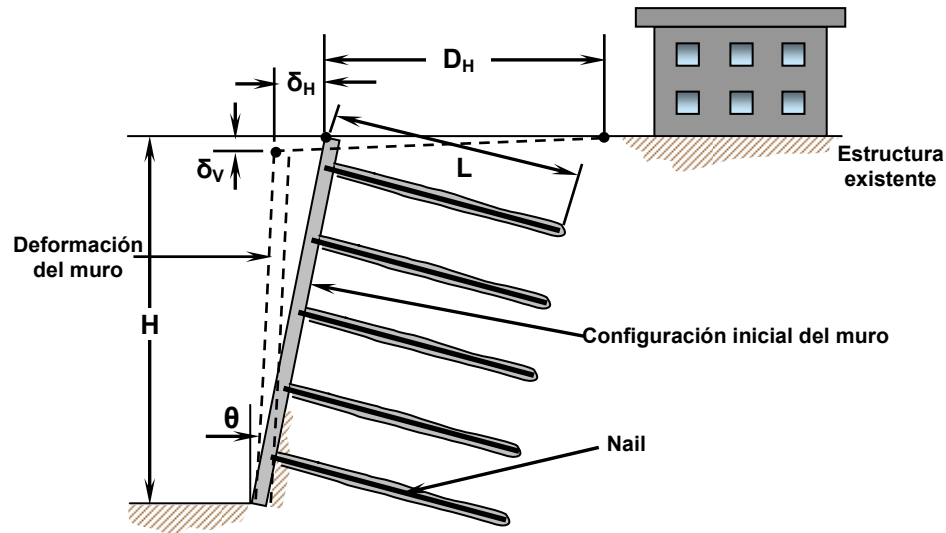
Deformaciones horizontales y verticales en muro Soil Nailing.
